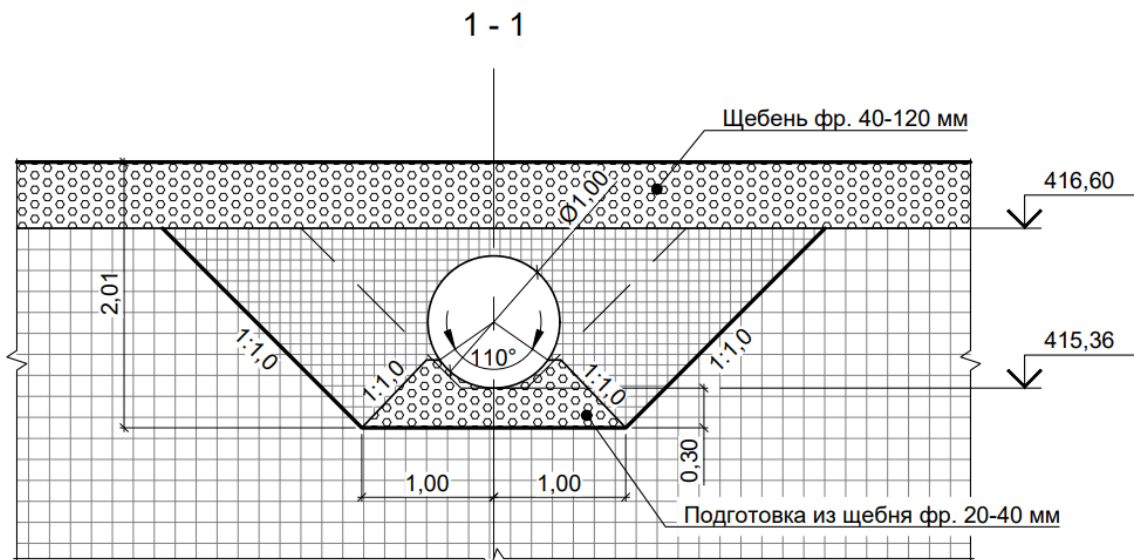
Проектное расчётное поперечное сечение водопропускной трубы
